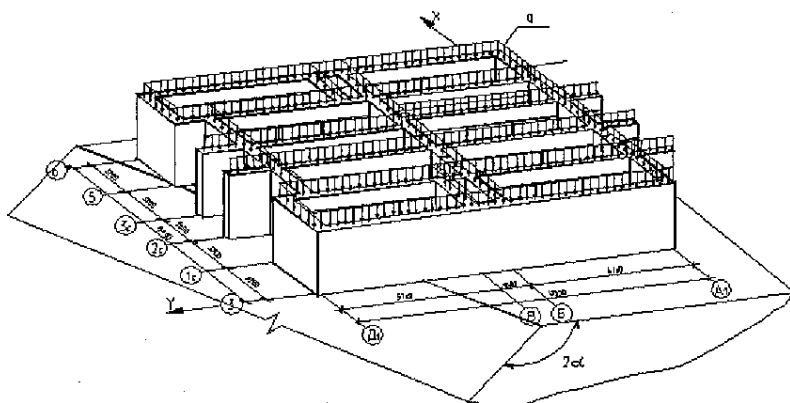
Монолитный железобетонный фундамент в виде системы перекрестных балок на упругом клиновидном основании
